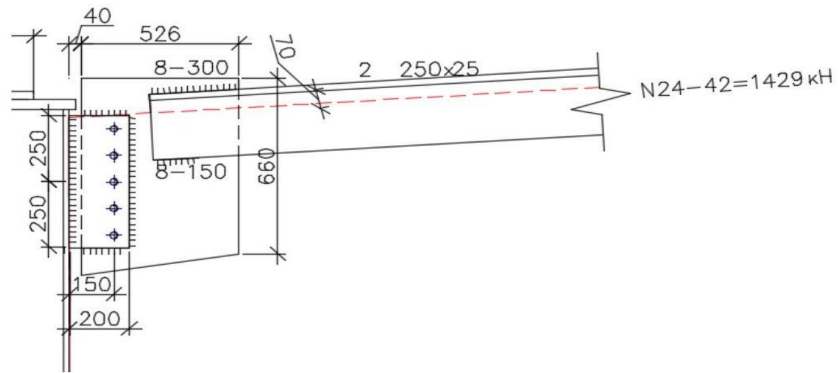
Верхній опорний вузол ферми (вузол 3)
